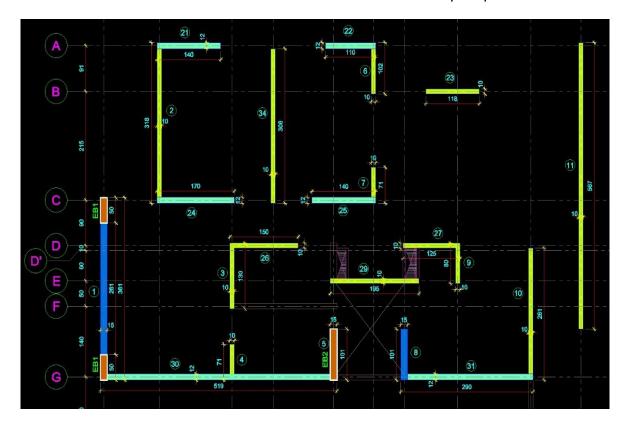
Planta de Distribución de muros estructurales por apartamento
